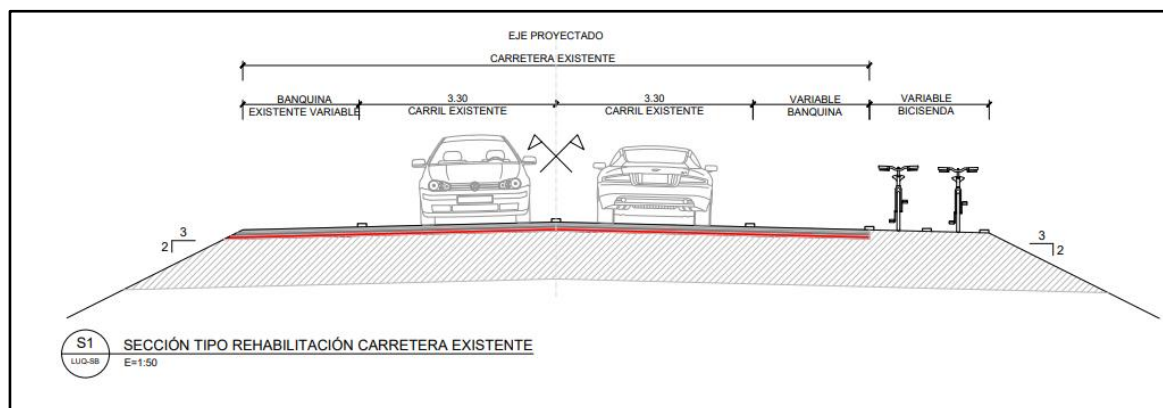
Sección tipo – Tramo 14 Rehabilitación
